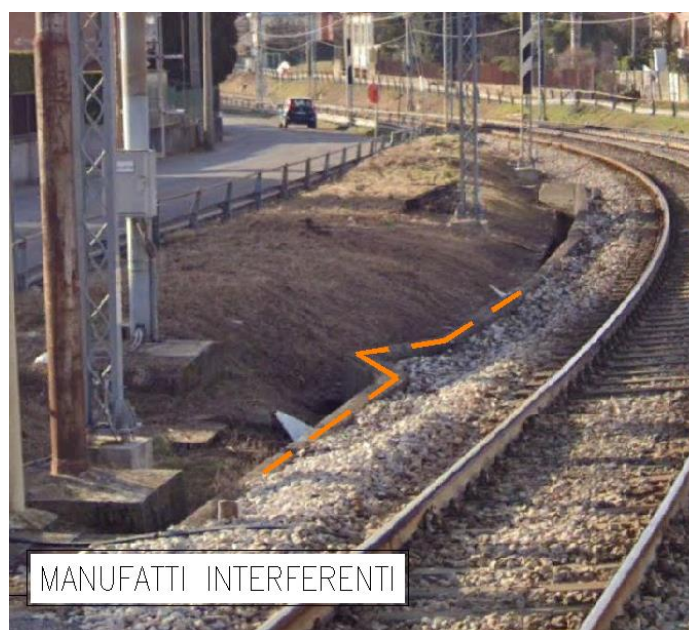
Vista in arancione della canaletta cavi FS lato via alla Fonte
